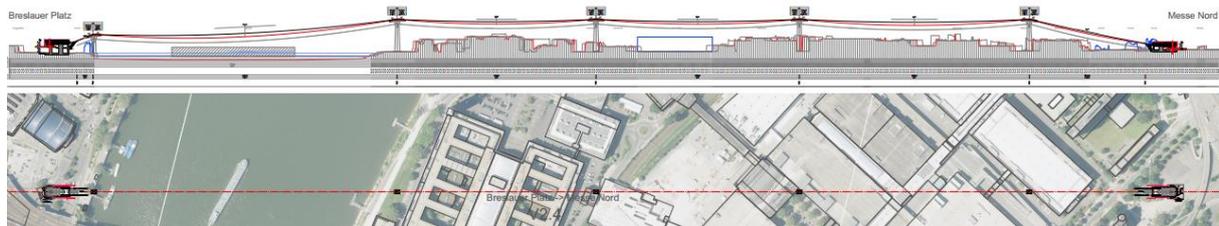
Längenschnitt, Lageplan Variante V2.4
